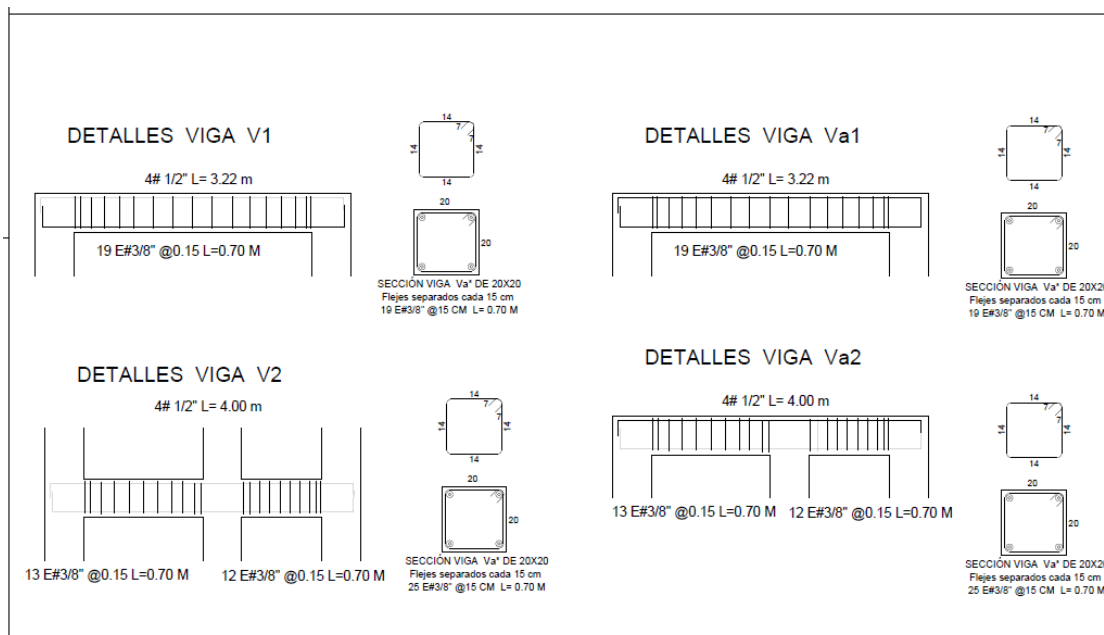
Detalle despiece de vigas de cimentación (V1 y V2) y vigas aéreas (Va1 y Va2) batería sanitaria Casa Cabildo
